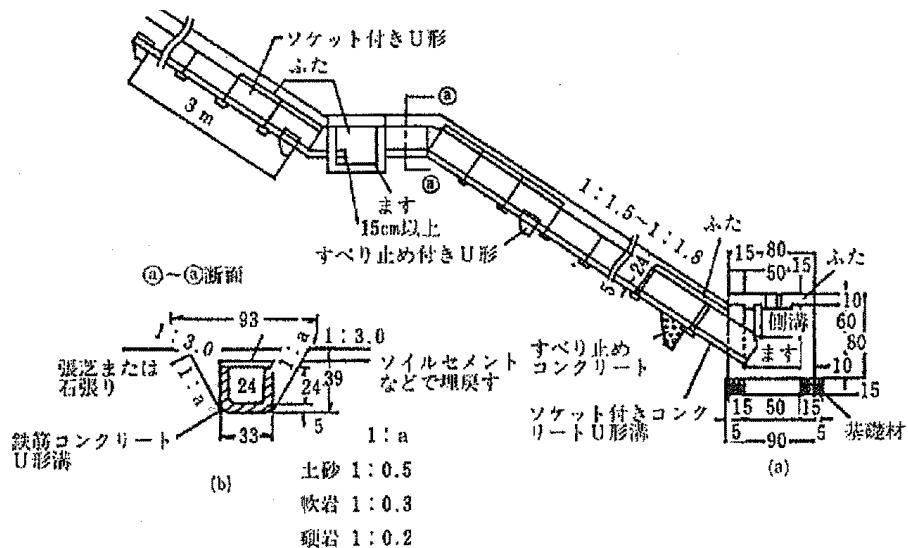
鉄筋コンクリート U 形溝による縦排水路の例（単位：cm）
